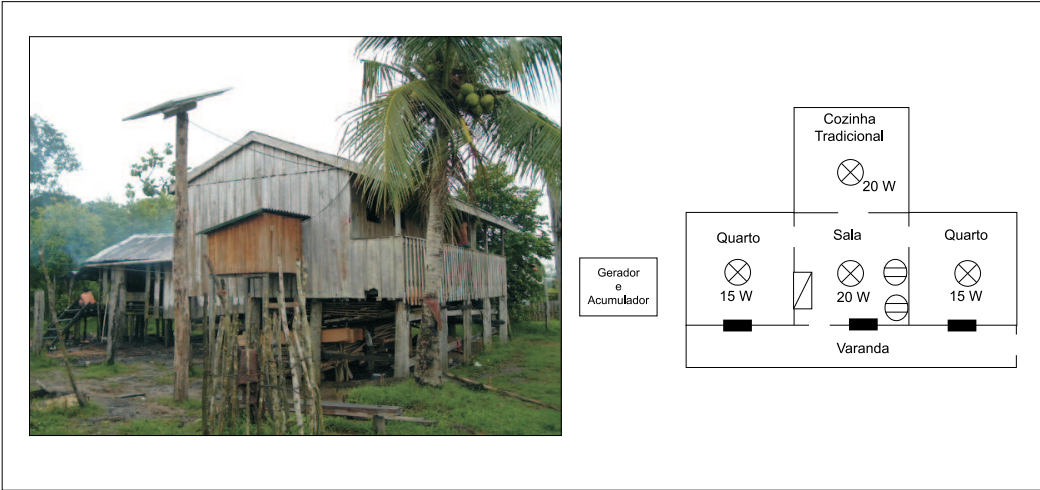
Vista externa do SFD17 e planta aproximada do domicílio.
